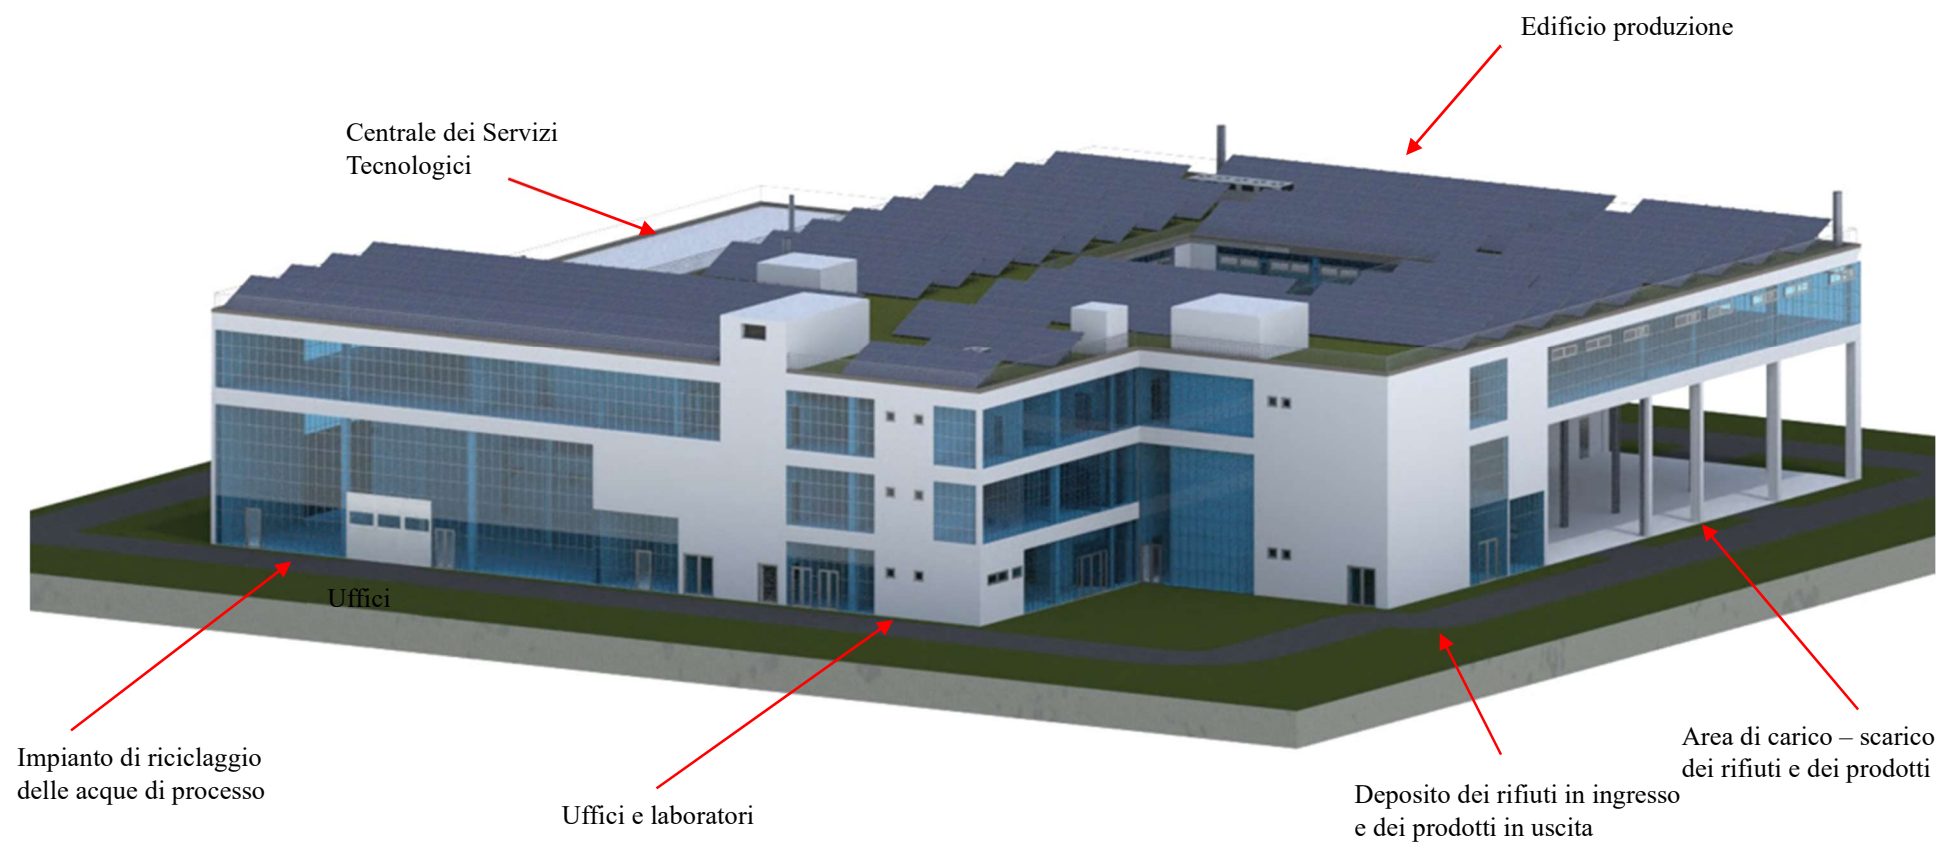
Vista assonometrica dello stabilimento da sud-ovest
